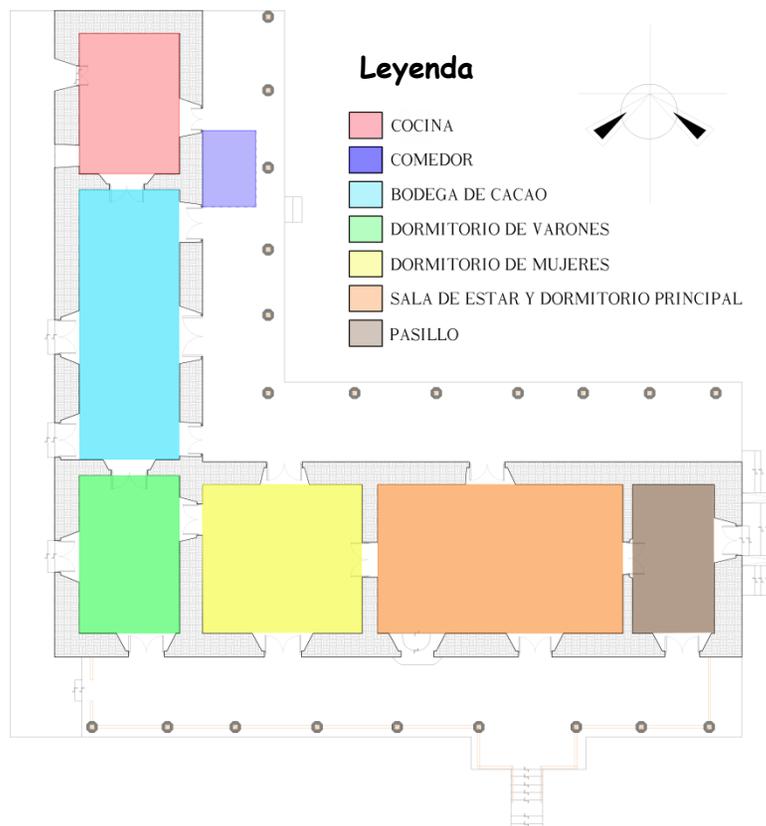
Planta con la distribución de ambientes originales de la Casa Hacienda Santa Úrsula.
